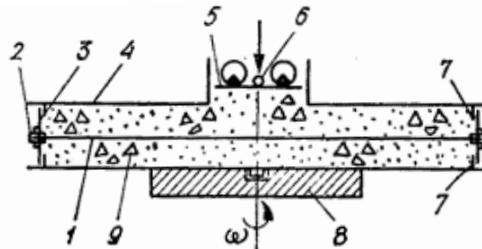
Конструкція у формі під час бетонування та натягу арматури
